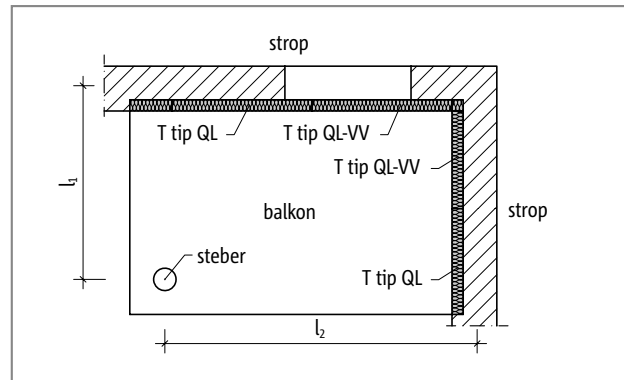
Schöck Isokorb® T tip QL: balkon z ležajem na stebrih
